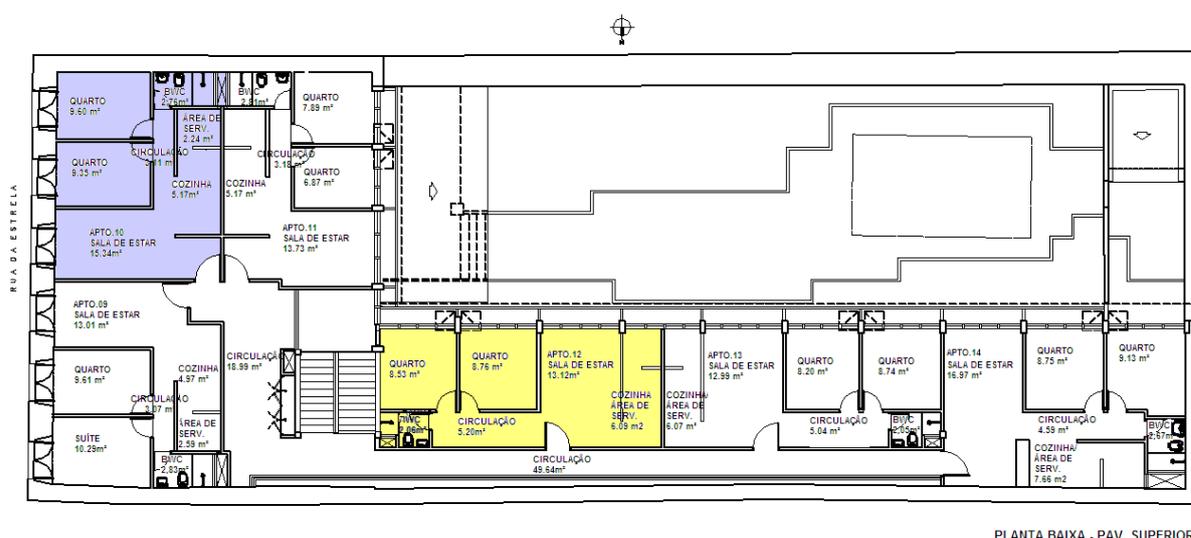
Ilustração de Planta Baixa de Pavimento Superior
